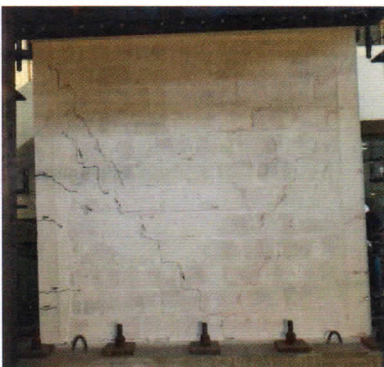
Continuación de grietas diagonales en el muro para una distorsión 1/1500 Vista cara Sur.
